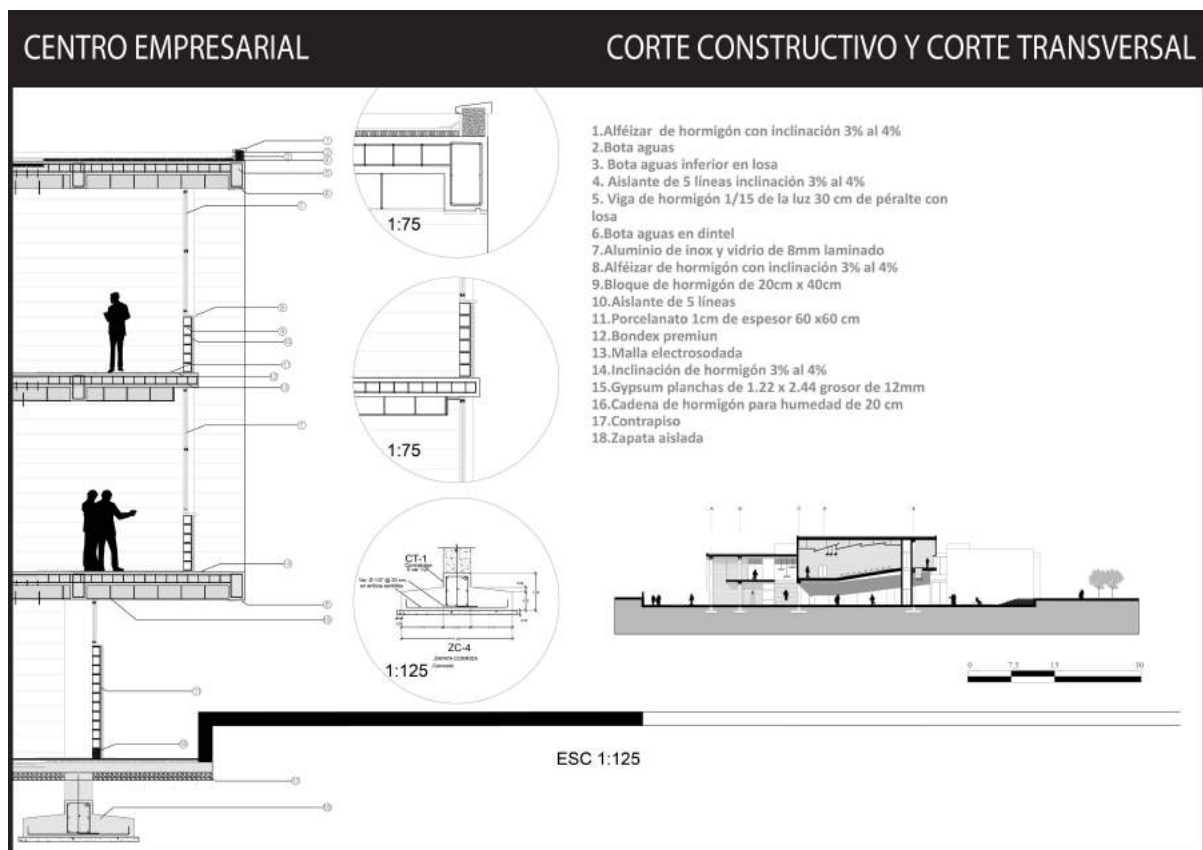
Detalle constructivo y Corte transversal. Elaboración propia.
